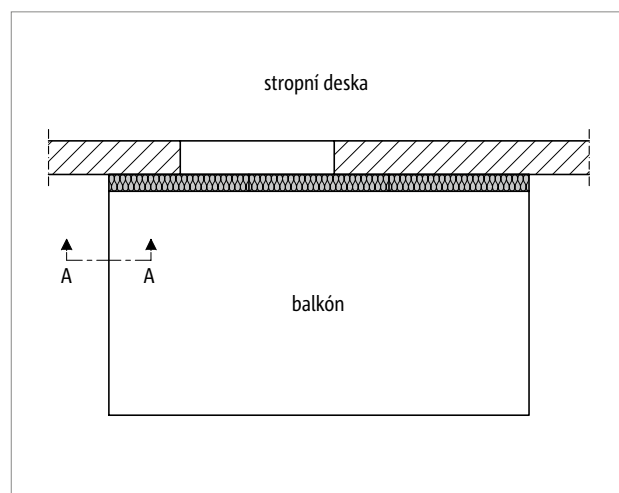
Schöck Isokorb® CXT typ KL: Napojovací stavební výztuž u nepřímého uložení
